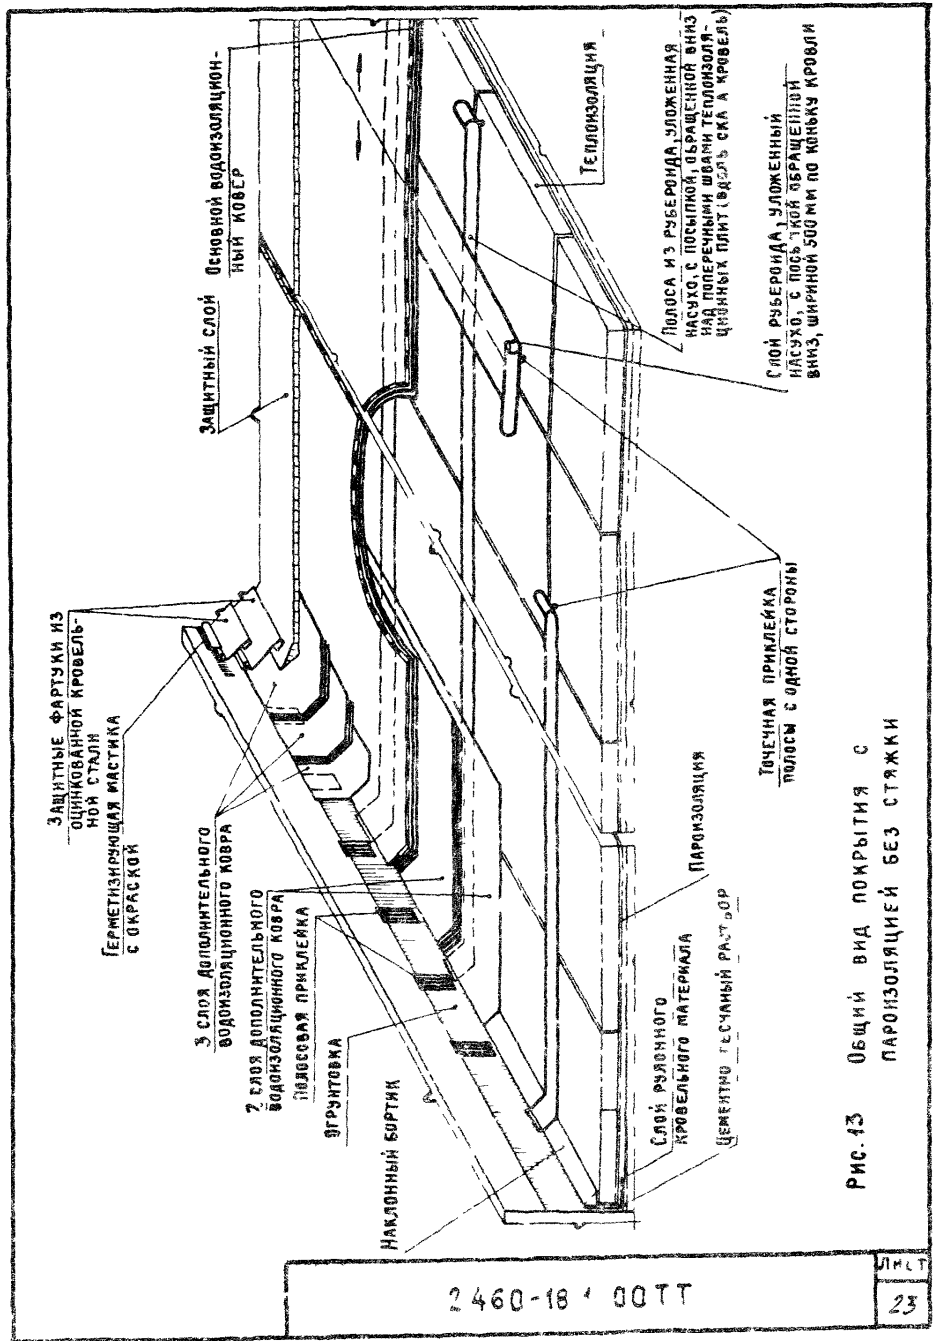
Общий вид покрытия с пароизоляцией без стяжки
